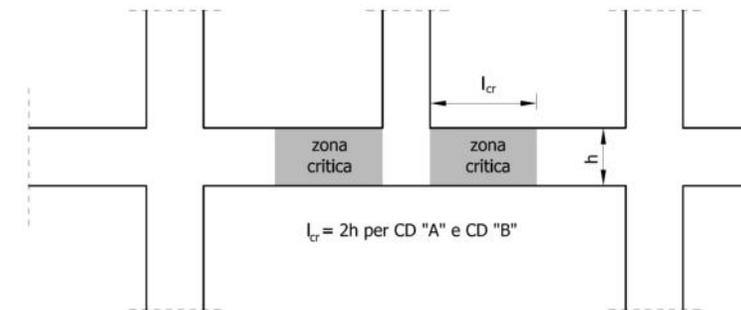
Zone critiche in corrispondenza di un pilastro in falso (NTC08 § 7.4.6.1.1)
